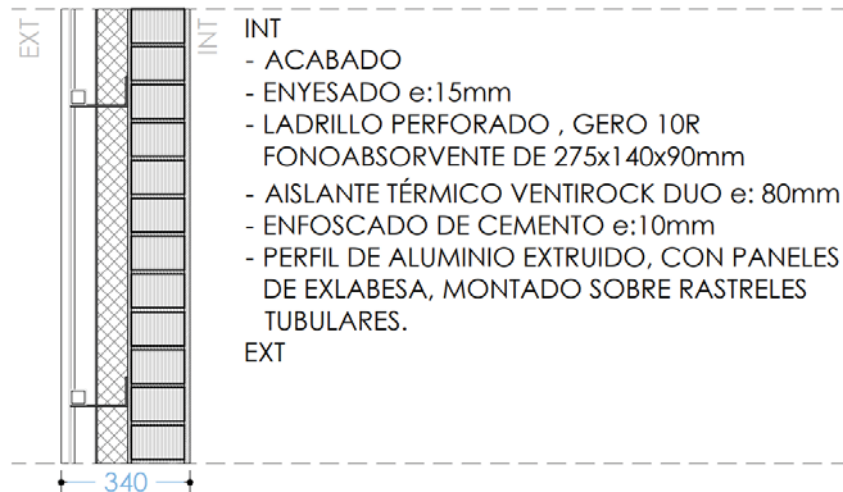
Esquema de la fachada Sur de las viviendas original del edificio.
